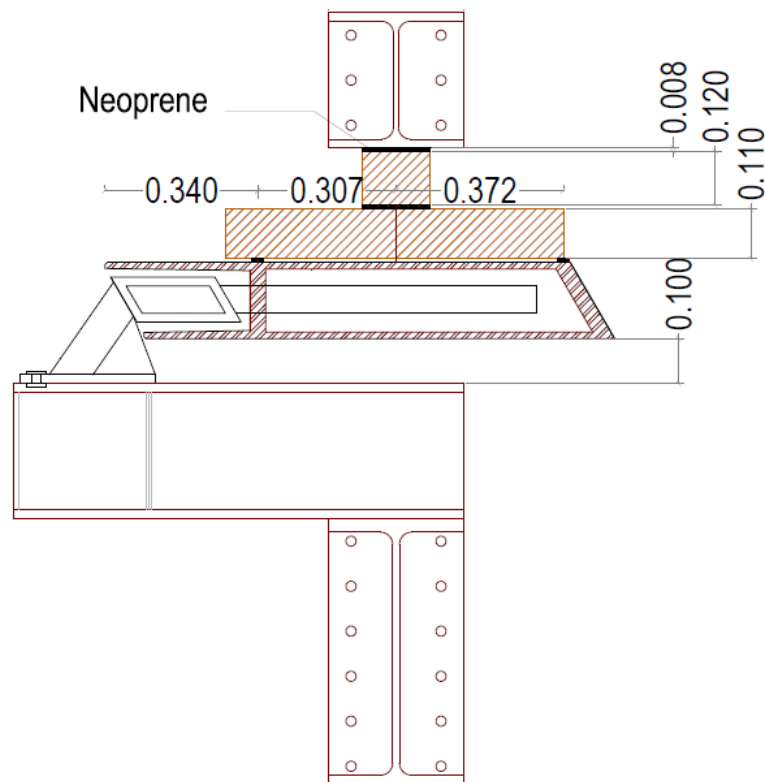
Corte B-B da Figura 5.12 (dimensões em m)
